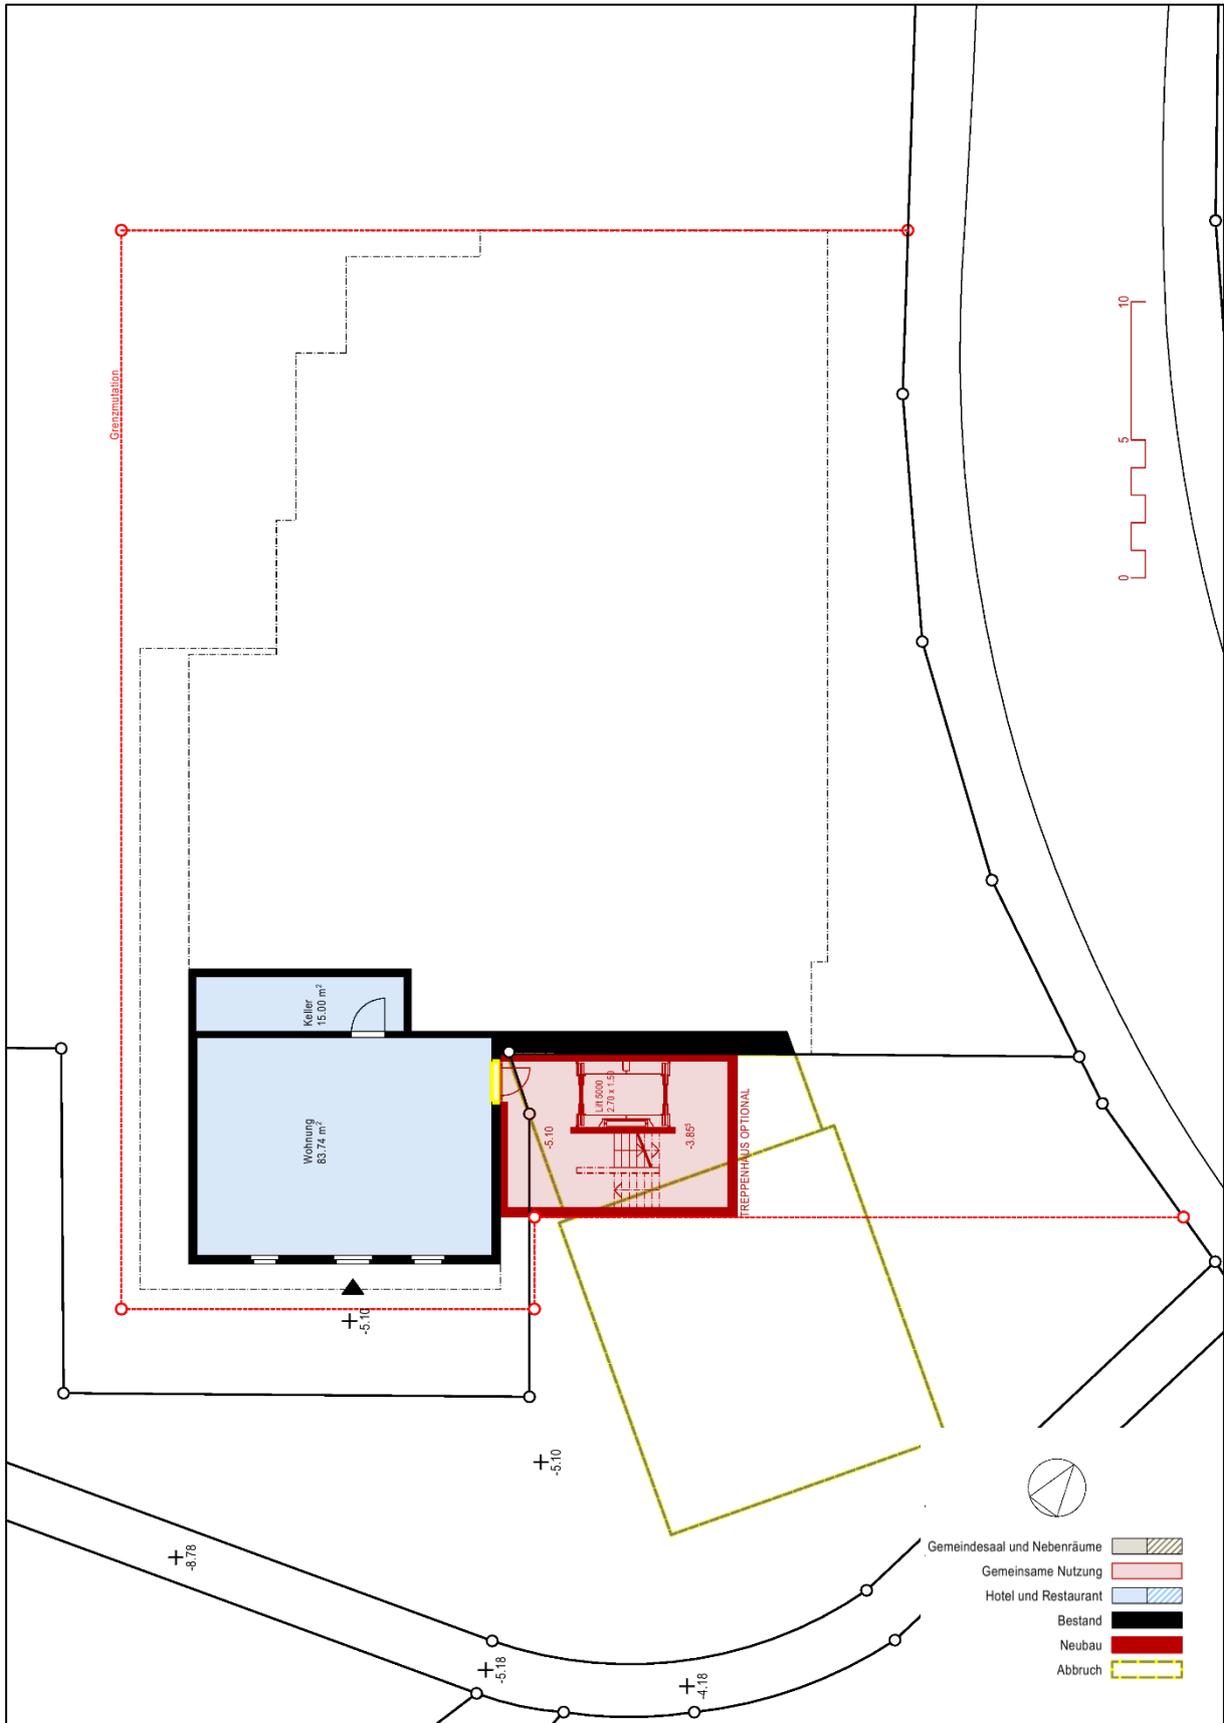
Grundriss 2. Untergeschoss, mit Distanzangabe, Stand: 3.11.2022
